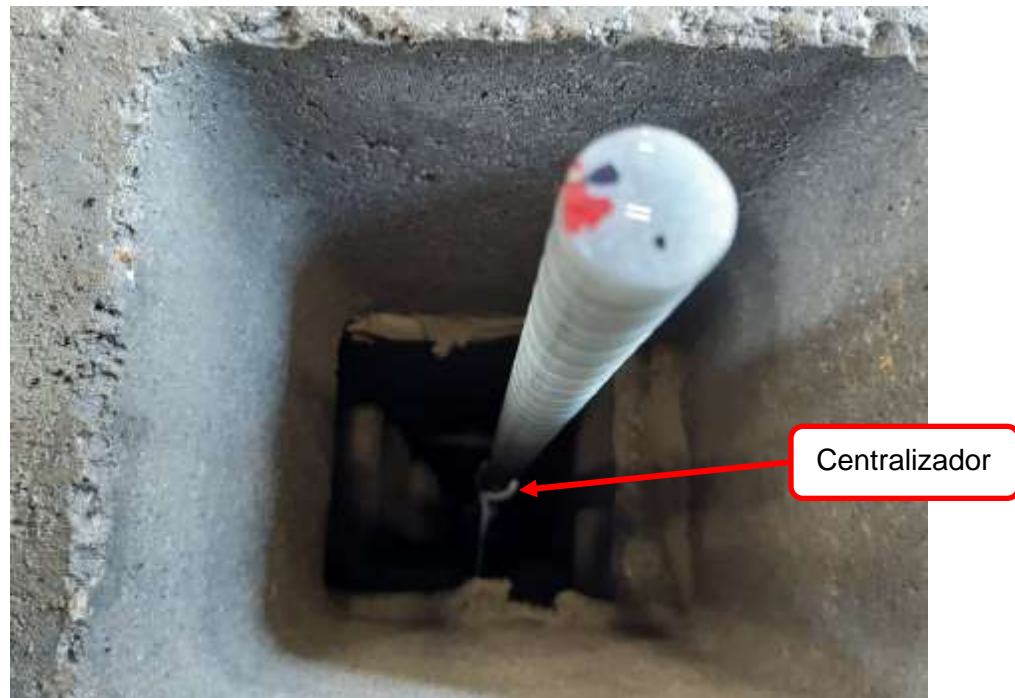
Elaboración de muro de mampostería de concreto
